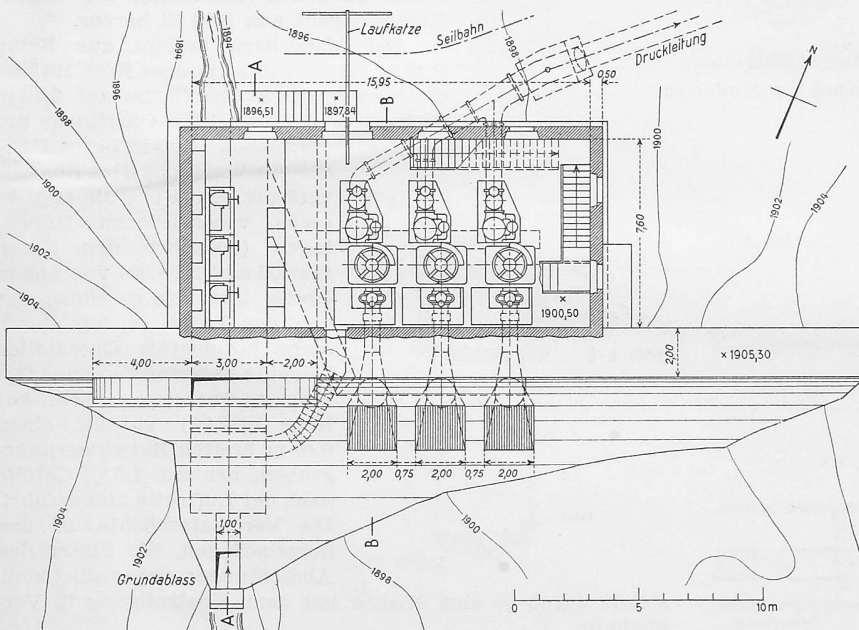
Grundriss des Pumpenhauses 1:300
